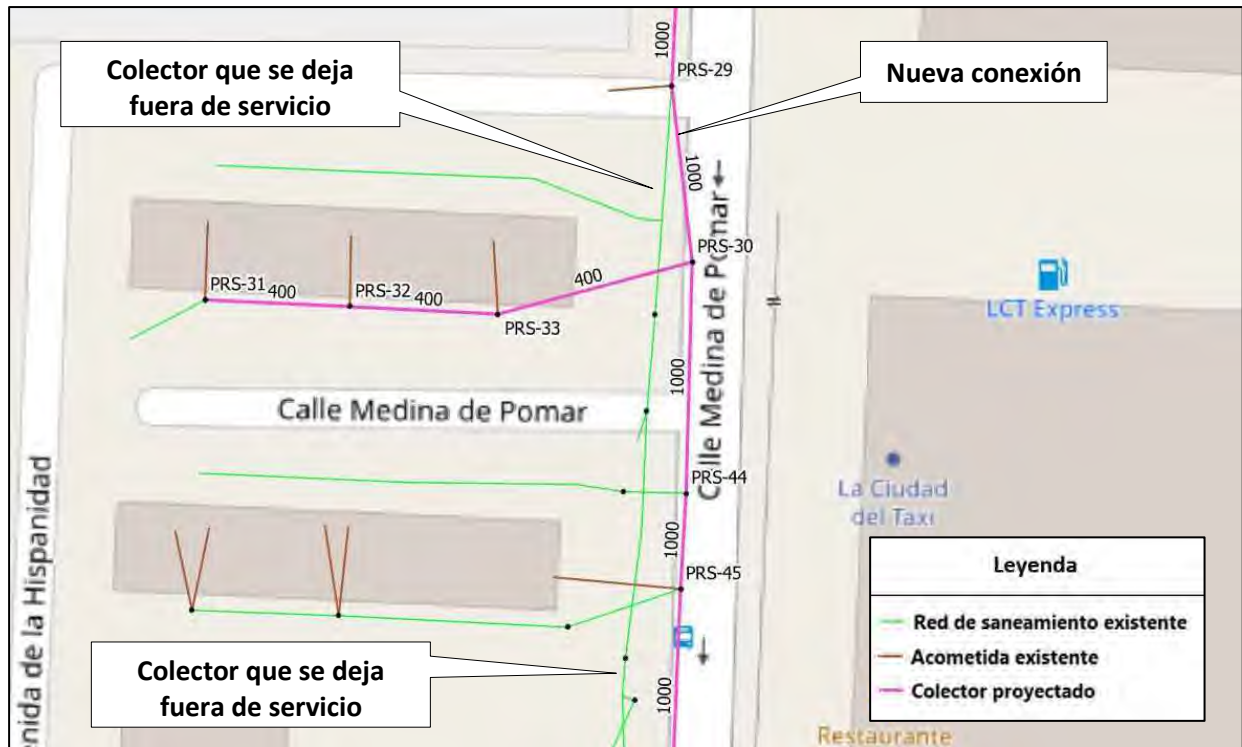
Colector proyectado en la calle Medina de Pomar. Planta de la actuación. Detalle 1.
